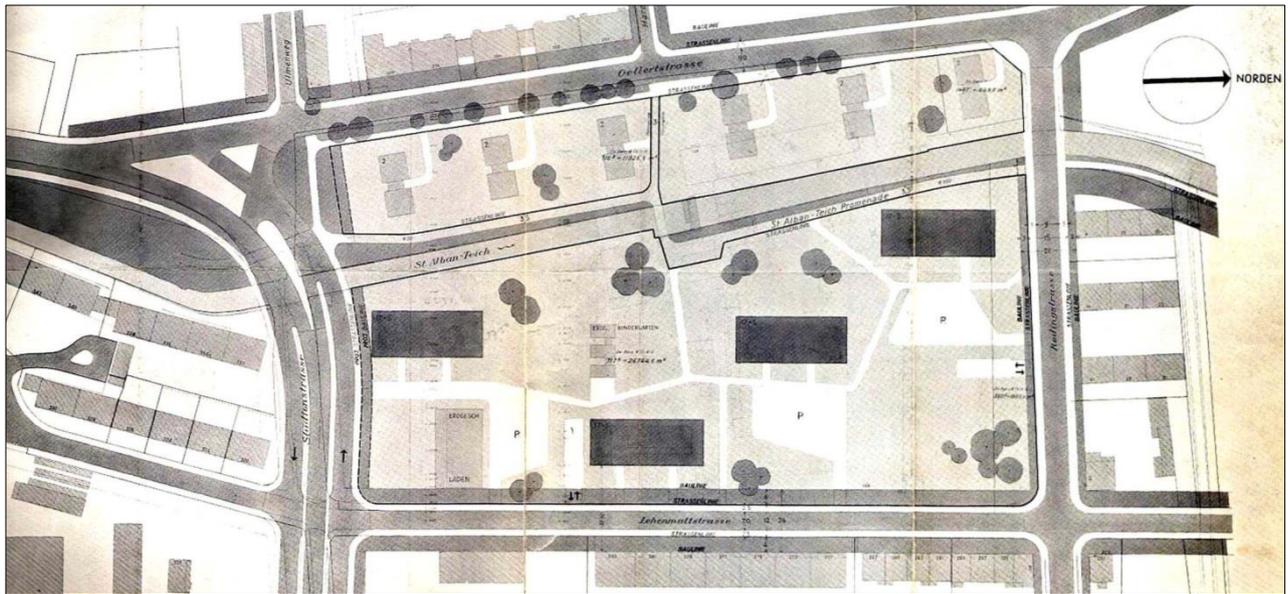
Bauungsplan Nr. 73 (kein Massstab, Plan nicht genordet)
